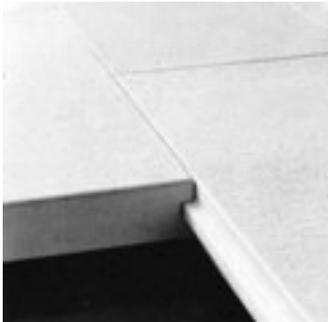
Mit Leichtmörtel beschichtete Styrodur® LDE-Platten. Die Platten können auf der Baustelle mit Holzbearbeitungswerkzeugen zugeschnitten werden. Dies spart Zeit und Kosten
